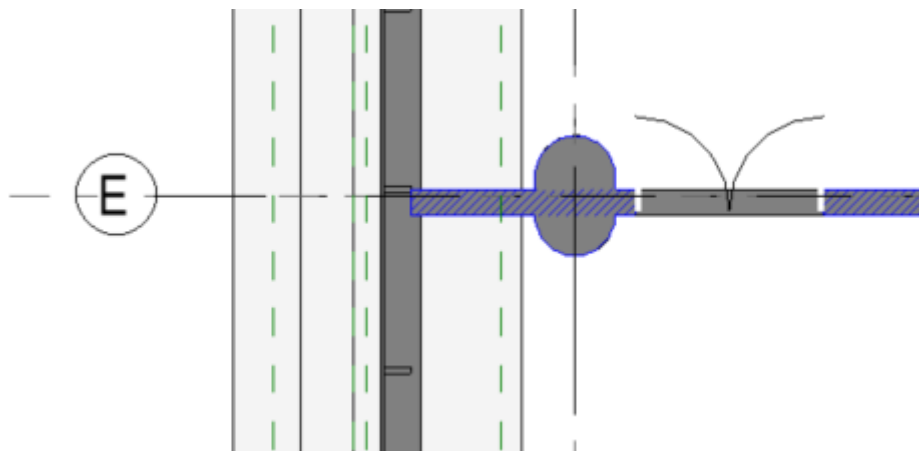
Conflito entre o elemento "Structural Column" e o elemento "Wall"
